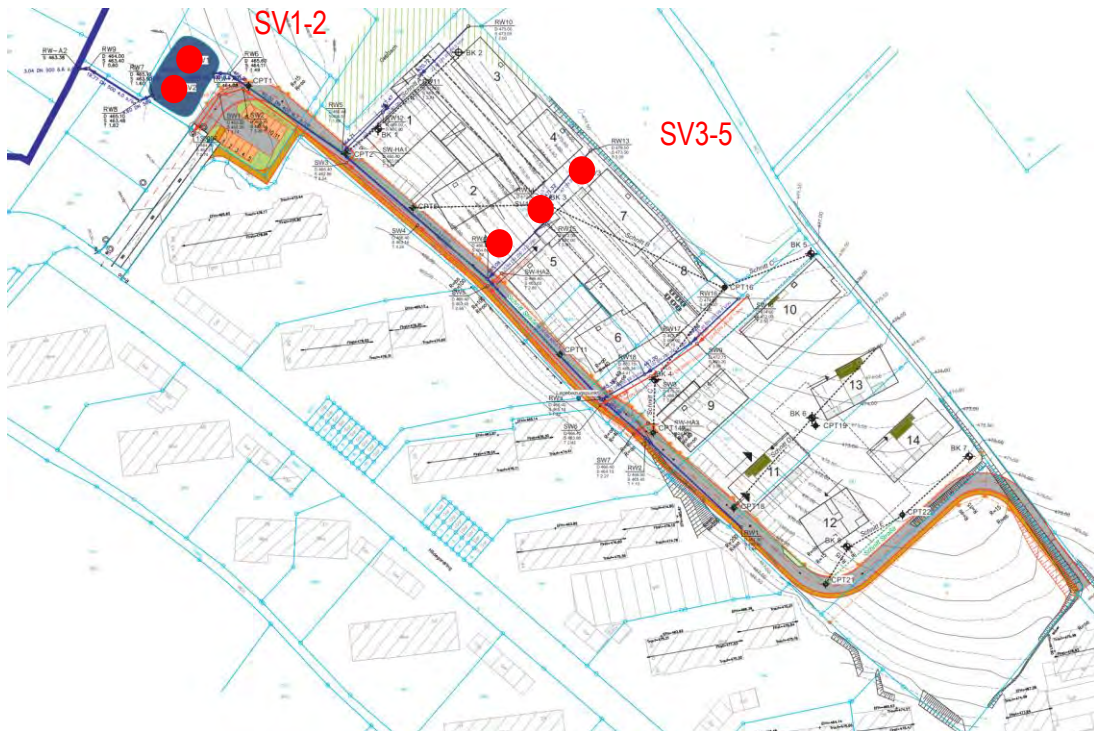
Lageplan Standorte Versickerungsversuche Geotechnischer Untersuchung KSW Ingenieure Juni 2016
